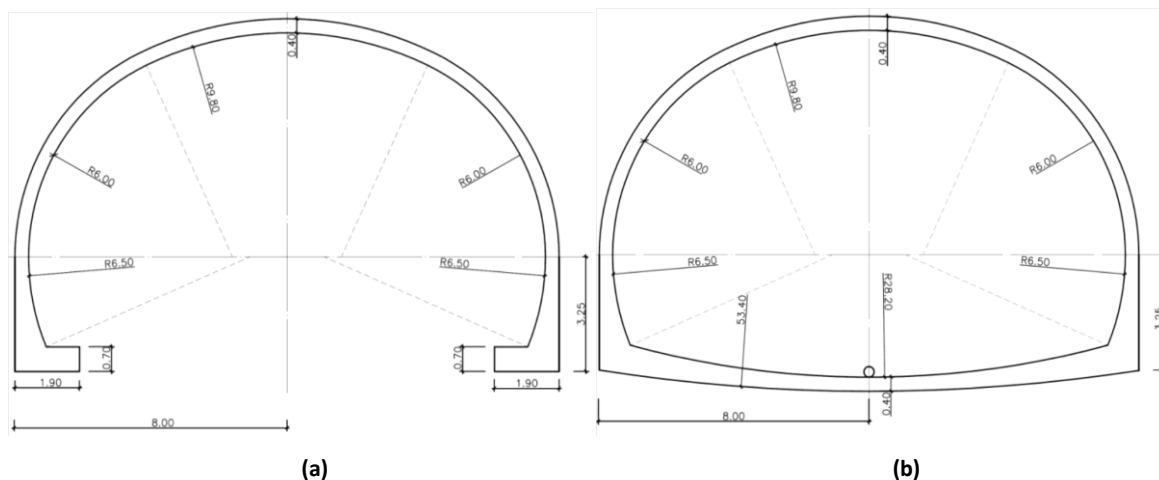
(a) Secção tipo I e (b) secção tipo II (adaptado de Coba, 2009)
